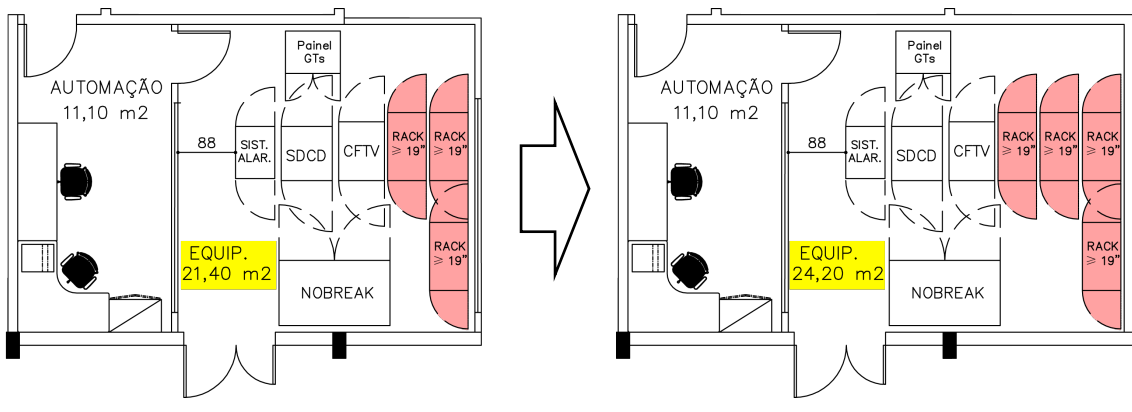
Alteração de layout sugerida pelo engenheiro de automação
